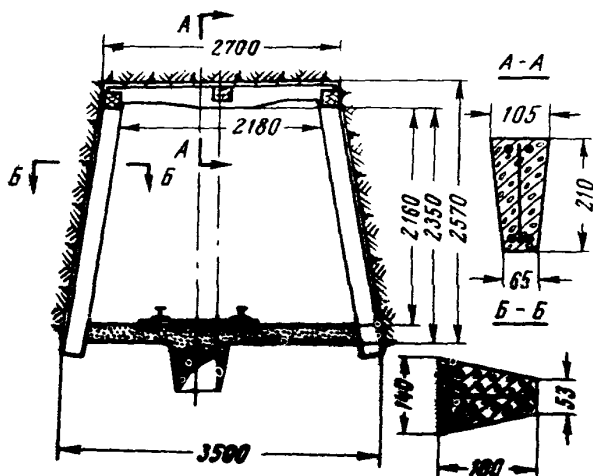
Железобетонная трапециевидная крепь из элементов трапециевидного сечения
